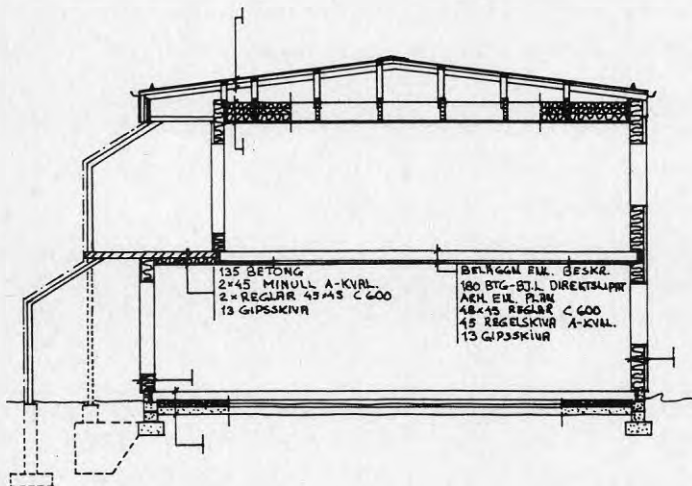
Sektion genom trapphuslägenhet, 2 RK i ovanplan samt 2½ RK i markplan
